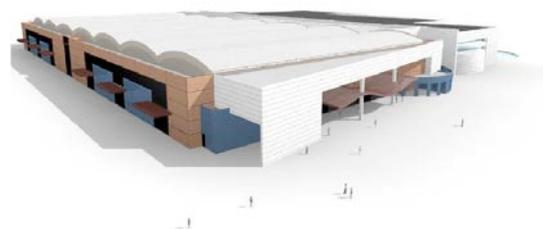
Vista do pavilhão de feiras (fonte: SEINFRA, 2002a).
